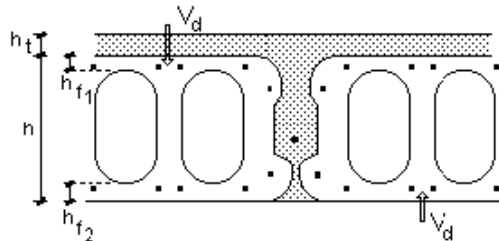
Esfuerzo cortante en la junta de losa alveolar pretensada.
